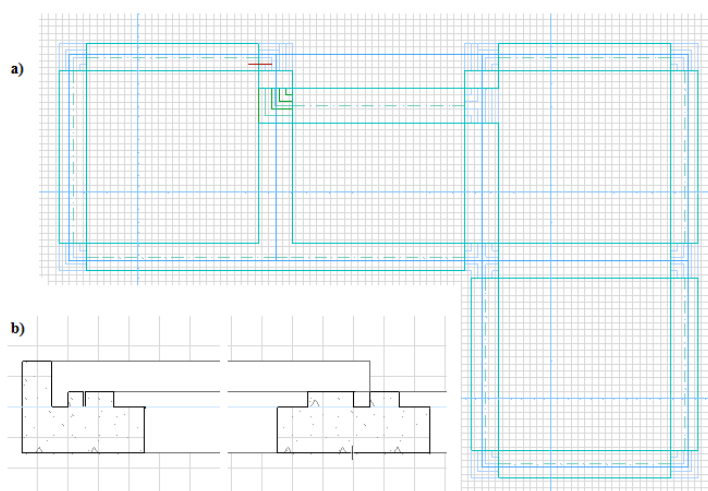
a) Planta de Fundações do projeto de Arquitetura; b) Secções Tipo das Vigas
